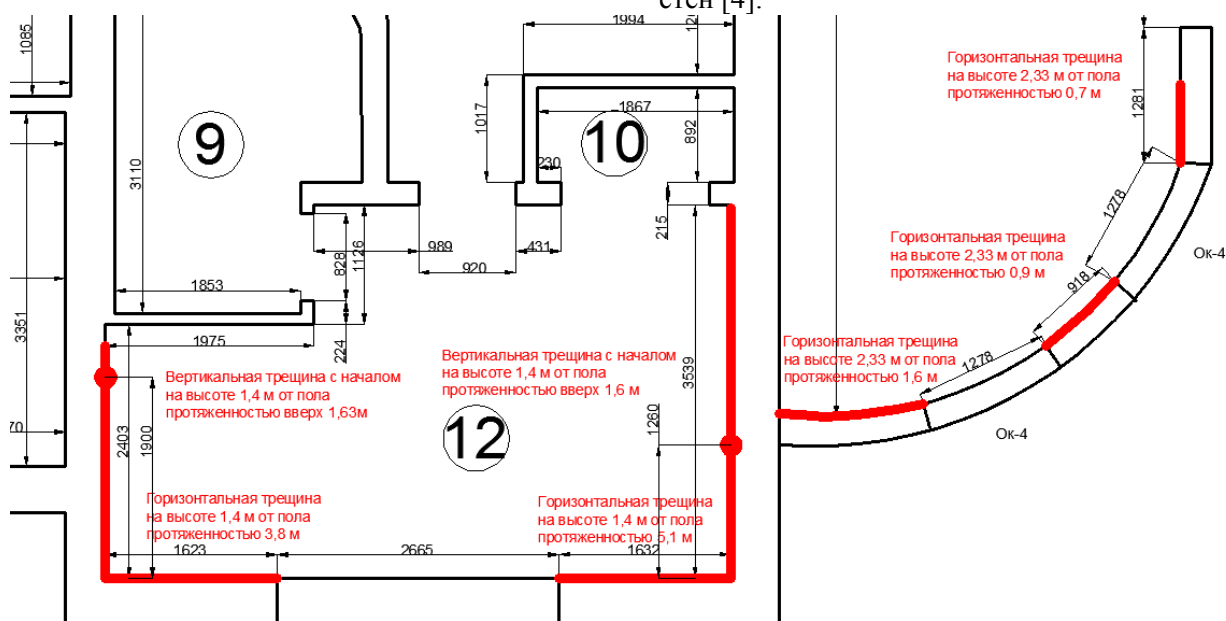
Фрагмент плана здания с указанием мест расположения трещин
